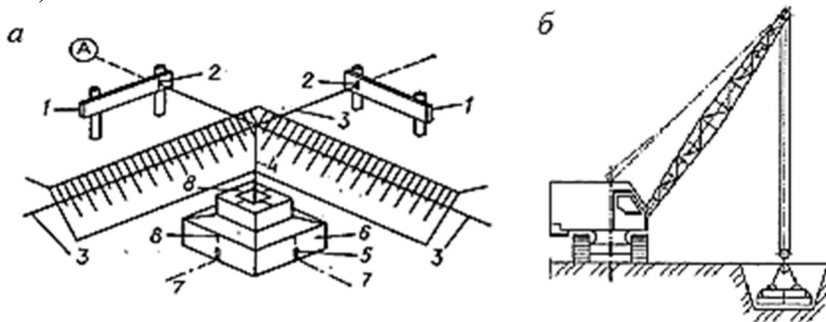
Схема геодезичного розмічування (а) та монтажу фундаментів (б): 1 – обгородження; 2, 8 – риски; 3 – дріт, що визначає положення осей; 4 – будівельний льон; 5 – кілочки-фіксатори; 6 – фундамент; 7 – осі
